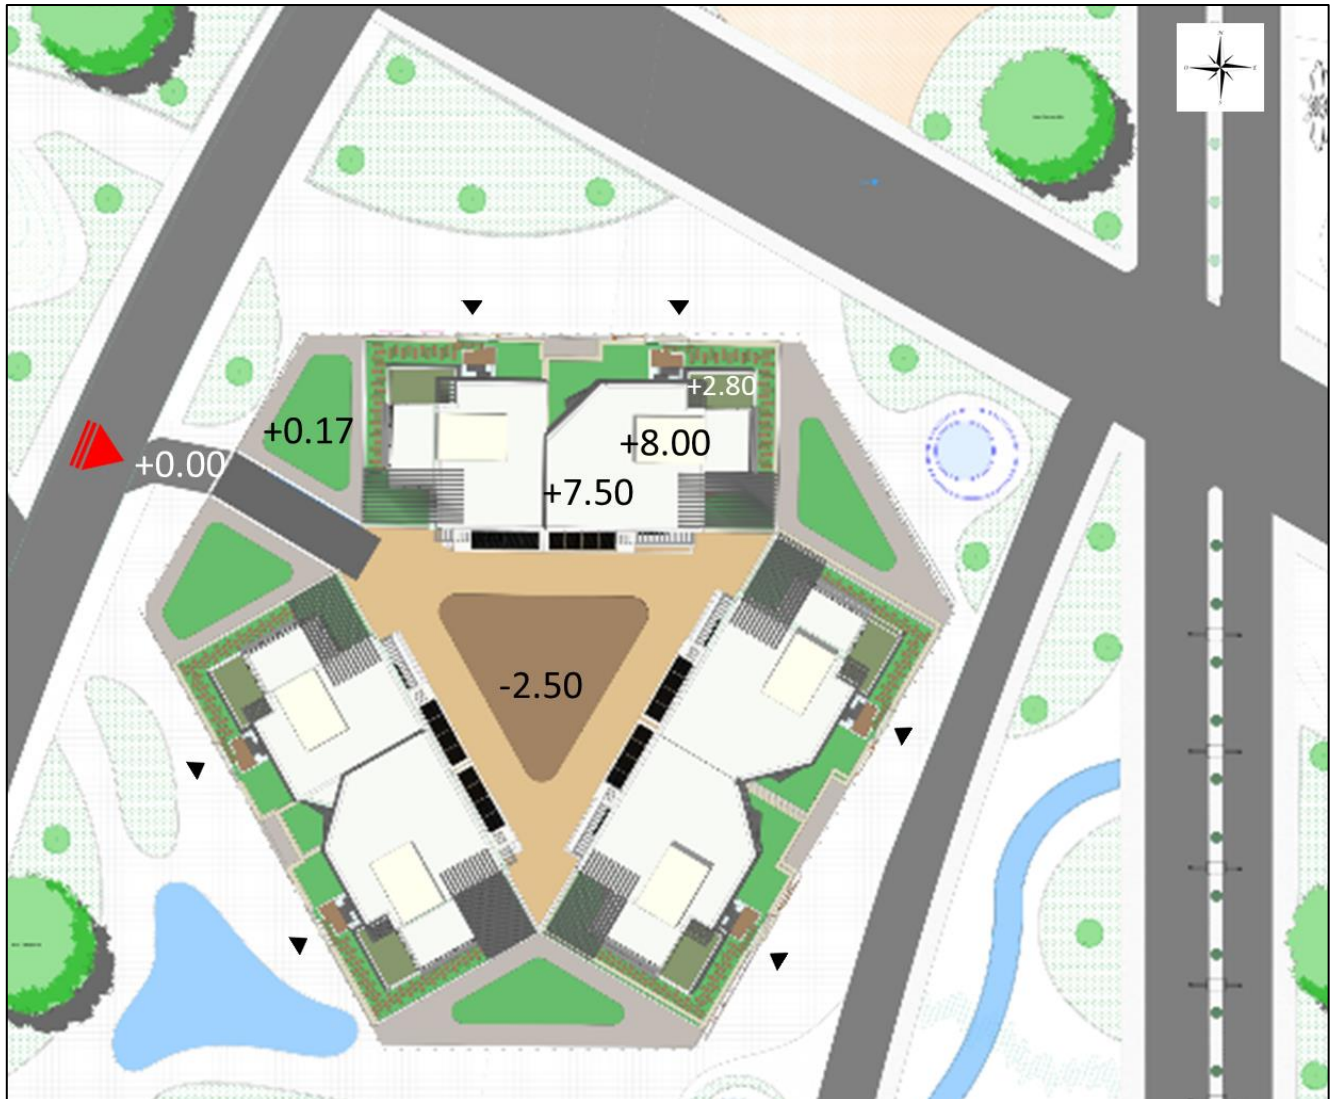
Plan de masse groupement (F5*4/F4*2) ech 1/500.
